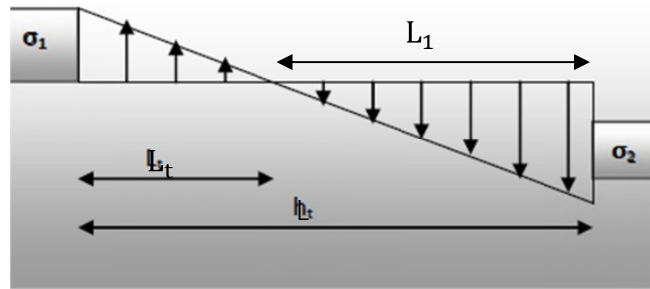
Schéma statique d'une section partiellement comprimée
